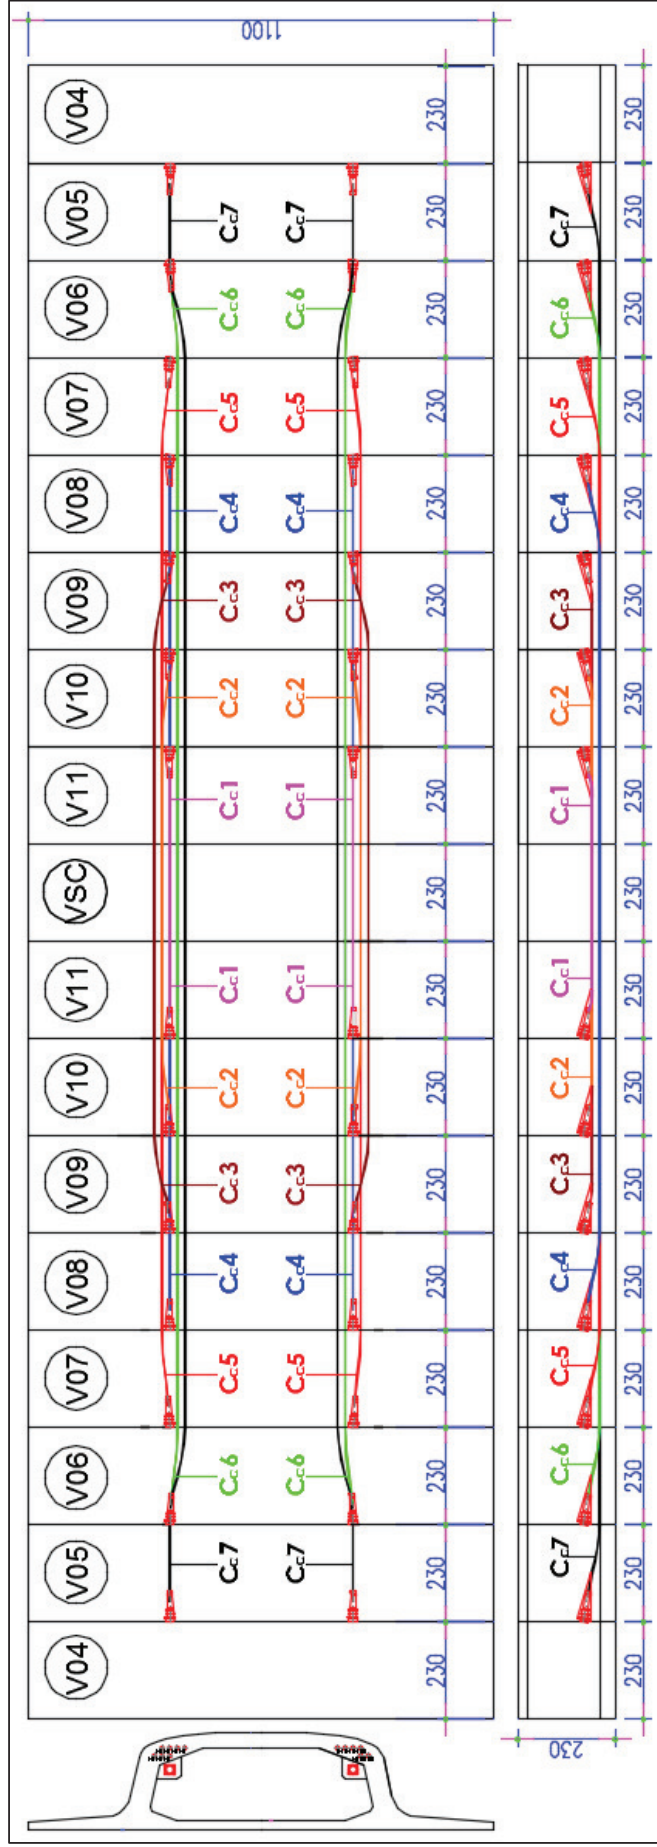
Tracé en élévation et en plan des câbles de continuité au niveau des clavages P1-P2/P2-P3/P3-P4/P4-P5.
